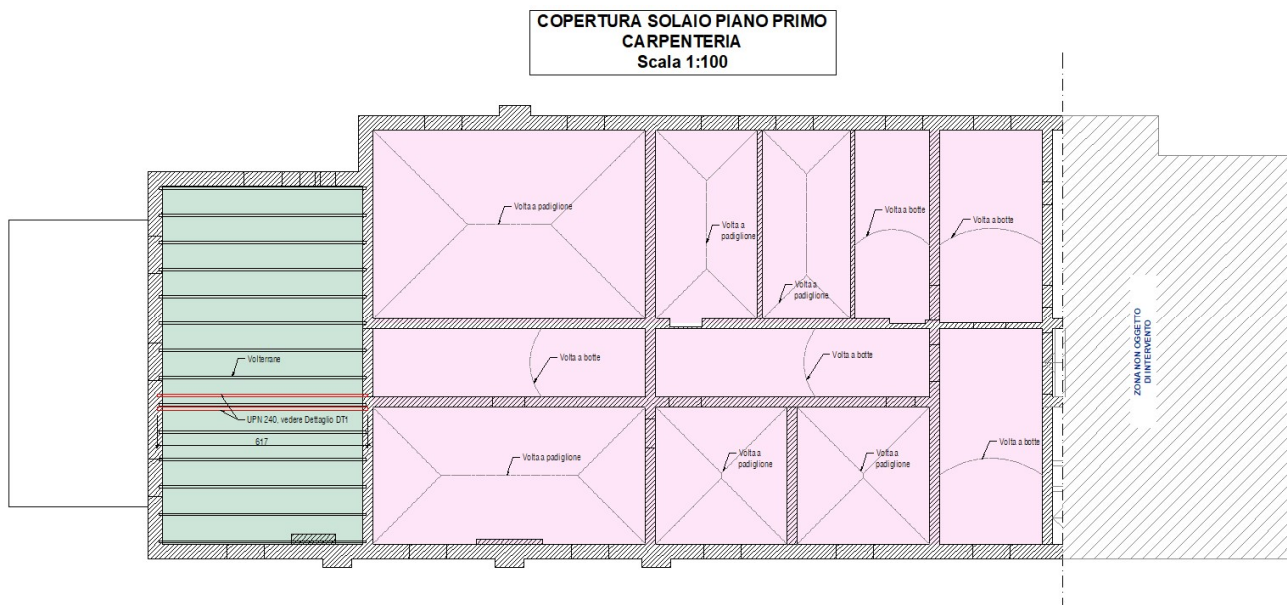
Carpenteria di progetto - solaio di copertura piano primo
